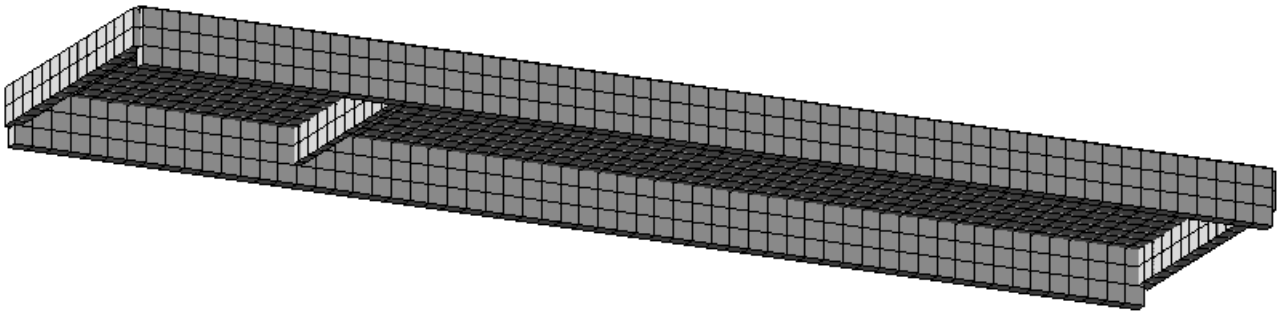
Плита перекрытия ПКЖ1 без 2-х поперечных ребер в ПК Лира САПР
